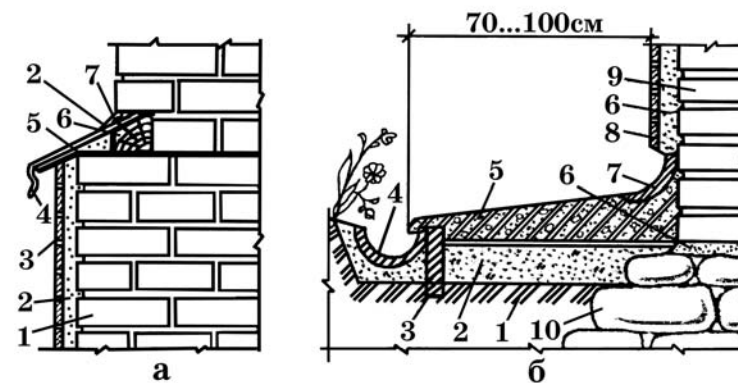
Выступающий цоколь: а – полочка слива: 1 – стена; 2 – цементно-песчаный раствор; 3 – керамическая плитка типа «кабанчик»; 4 – слив из оцинкованной кровельной стали; 5 – гидроизоляция (рубероид, толь и др.); 6 – деревянный брус; 7 – гвоздь; б – нижняя часть с отмосткой: 1 – материковый грунт (утрамбованный); 2 – песчаная подушка (8–10 см); 3 – вертикальная бетонная плита (полосой по периметру дома); 4 – лоток для сбора сливной воды с отмостки, сделанный из разрезанной вдоль асбестоцементной трубы; 5 – бетон (цемент) с заглаженной поверхностью; 6 – цементно-песчаный раствор, 7 – угловой стык стены (цоколя) с отмосткой, сделанный из четверти разрезанной вдоль асбестоцементной трубы; 8 – керамическая плитка типа «кабанчик»; 9 – стена; 10 – фундамент.
